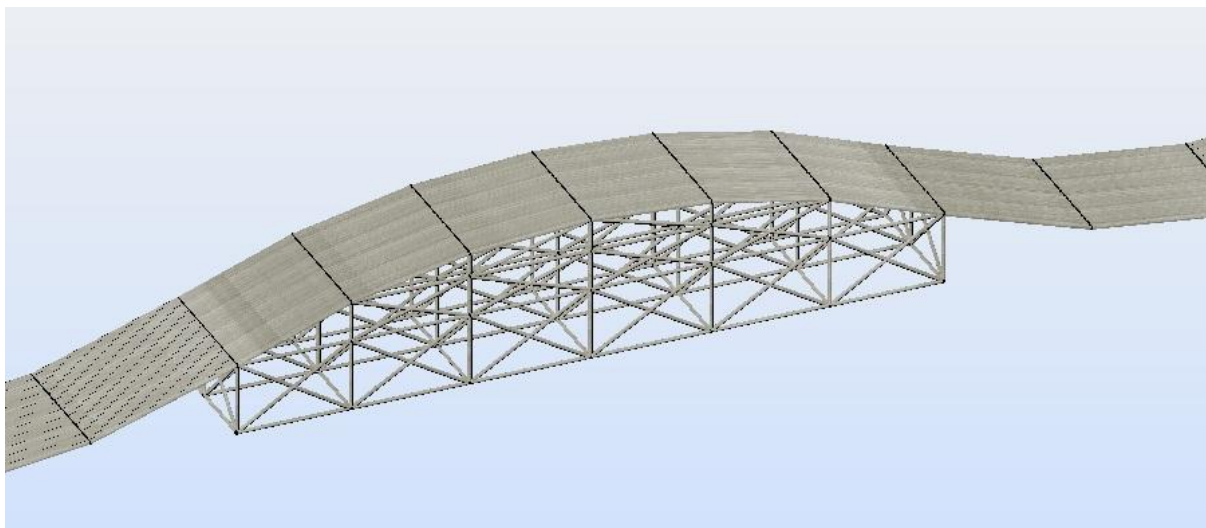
Esquema da zona central do tabuleiro apoiada sobre um cembre.
